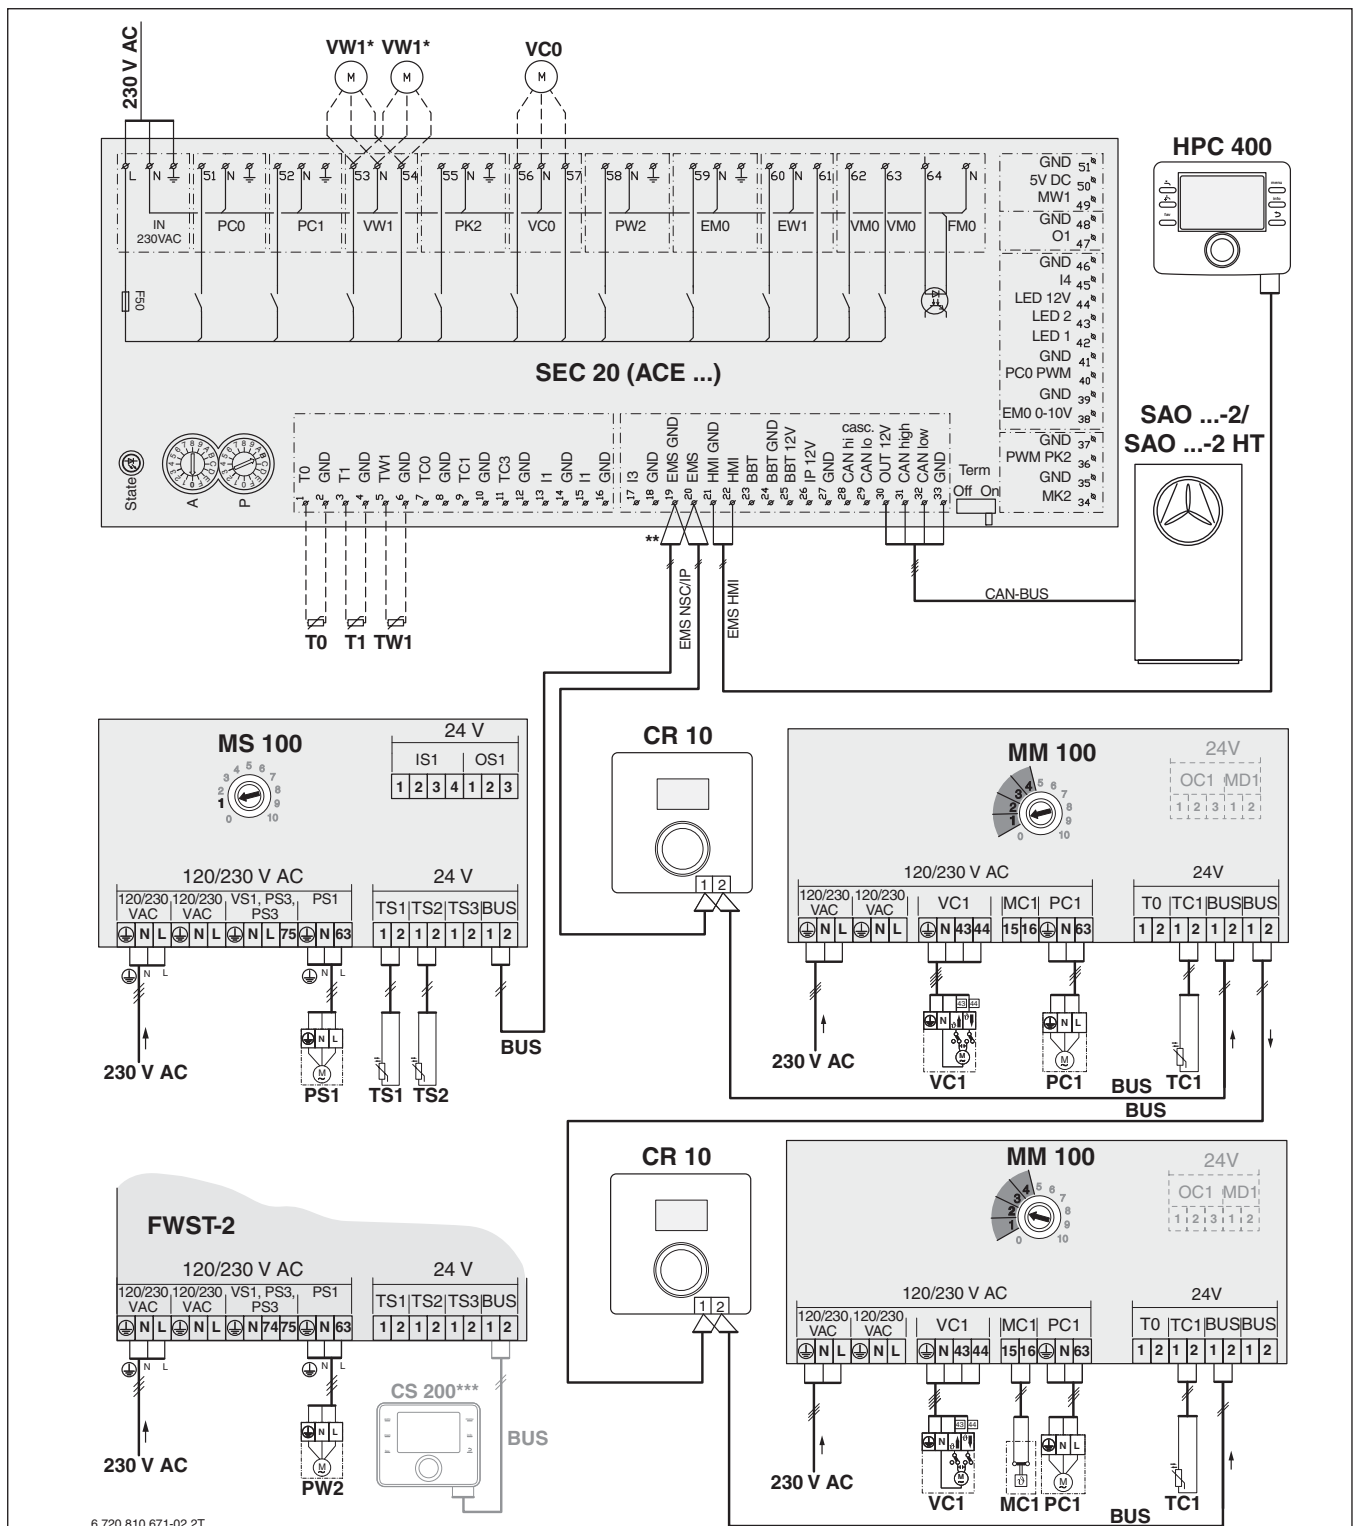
Schaltplan zum Anlagenschema (Legende → Bild 1)
